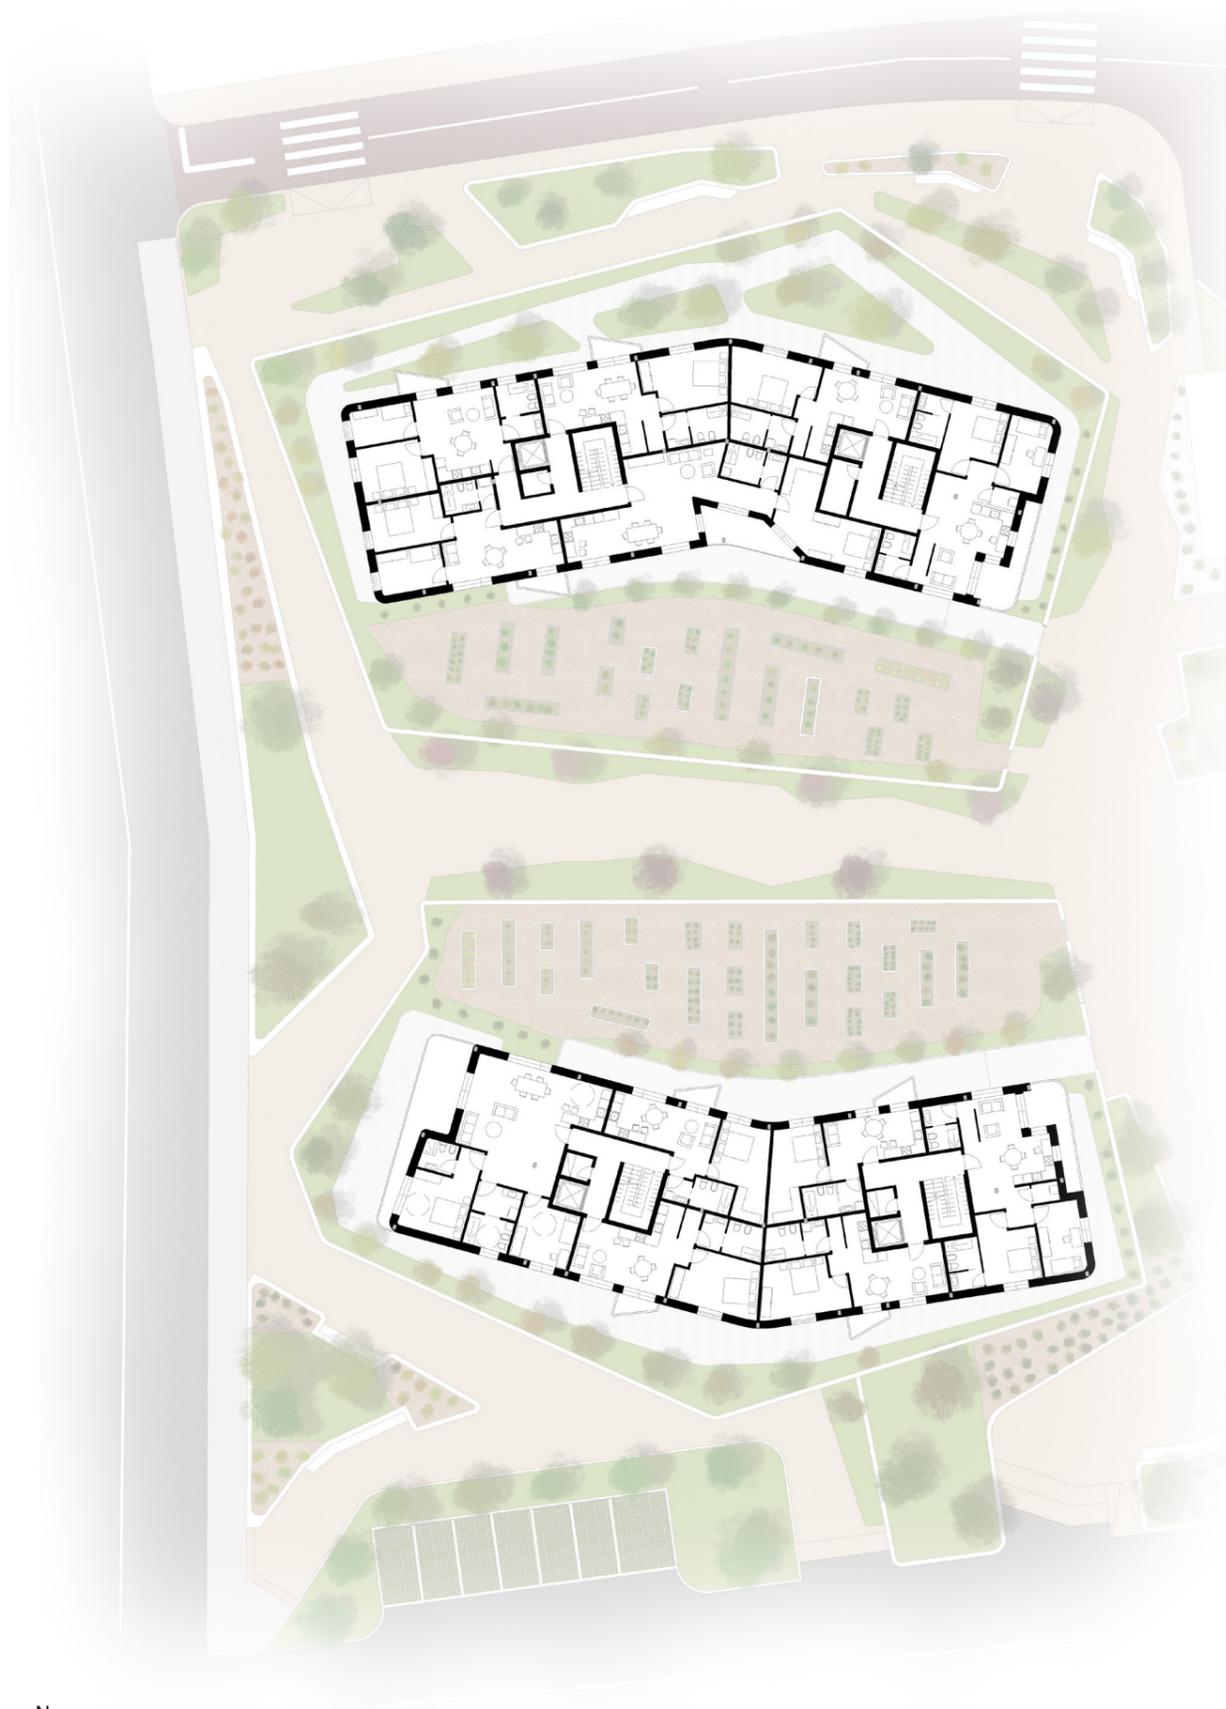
Planimetria piano 2 e 4 edifici A e B
